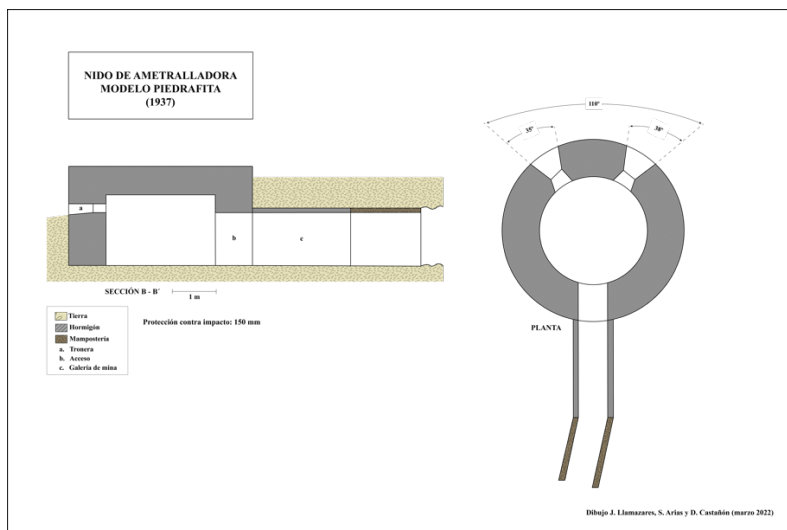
Plano en planta y sección del nido de ametralladora de la cota 1,449 (Piedrafita, Cármes, León). Autor: Javier Llamazares, Sergio Arias y Daniel Castañón.
